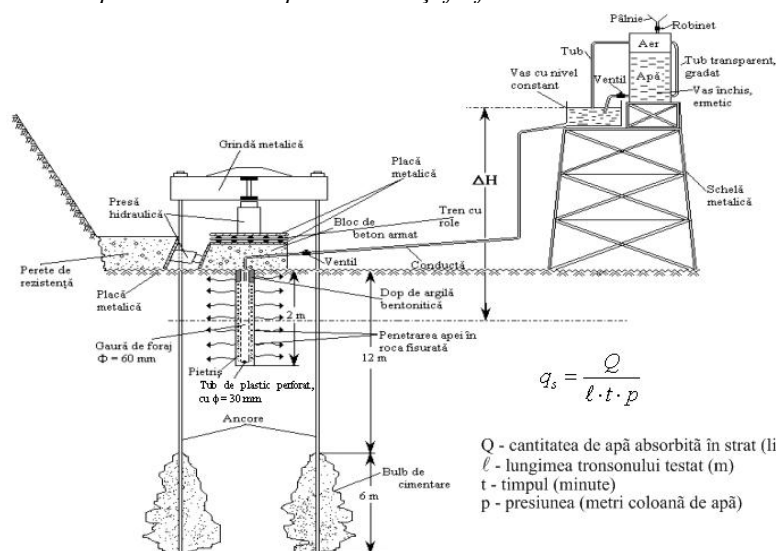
Schema de montare a echipamentului de compresibilitate, forfecare beton - rocă și permeabilitate (vedere în secțiune verticală)
